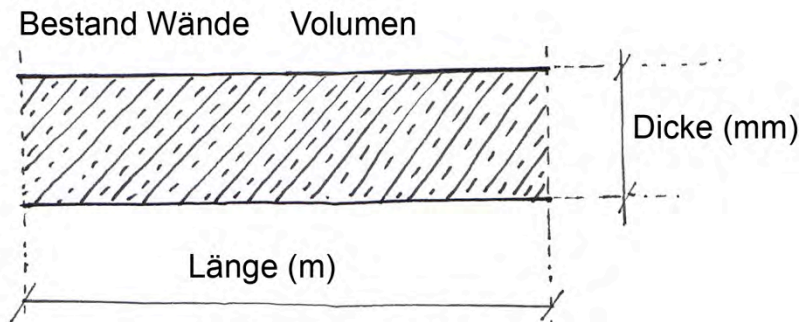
Bauteil, Vertikale Elemente , Gründung Bestand Beton Wand
